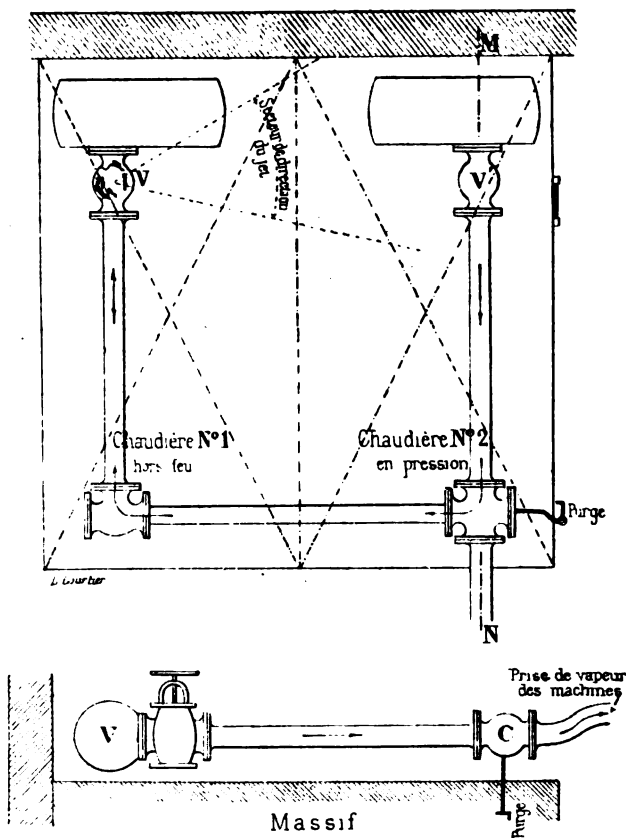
et 2. — Plan de l'installation, à Villefranche, et coupe suivant MN.
